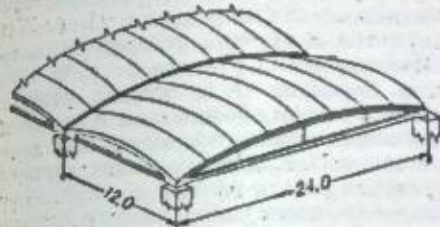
Схема сборной железобетонной оболочки положительной кривизны для покрытия производственного здания.
